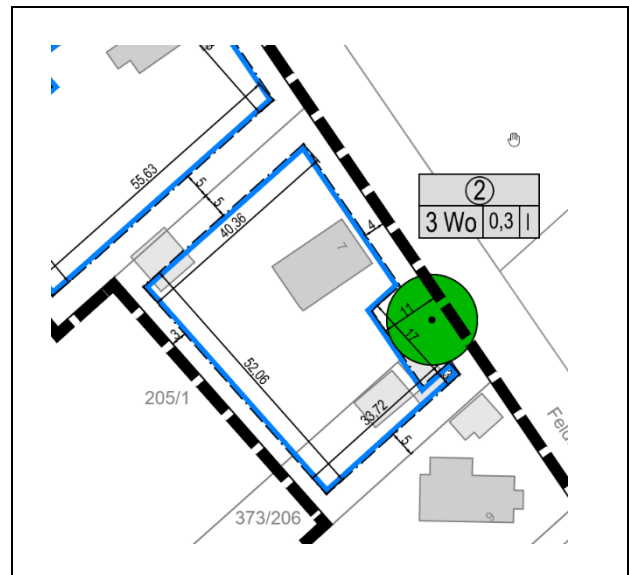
Hausnummer 7 - Lageplan (o.M.)
